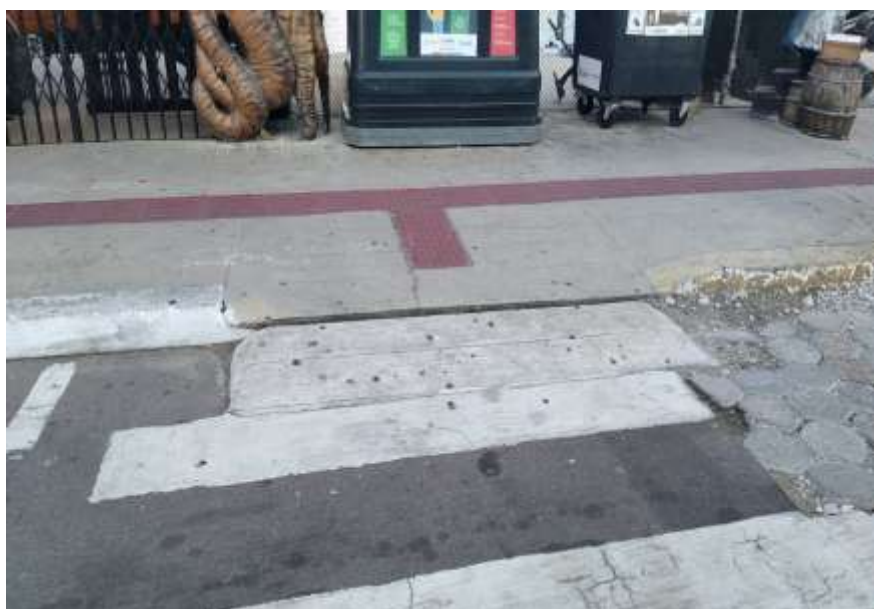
Calçada com rampa de acessibilidade em condições inadequadas, existente na Avenida Normando Tedesco, do lado oposto da estação barra sul.
